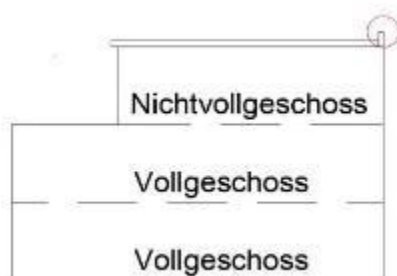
Systemskizze zur Definition der Oberkante bei Flachdachgebäuden (Attikahöhe)
